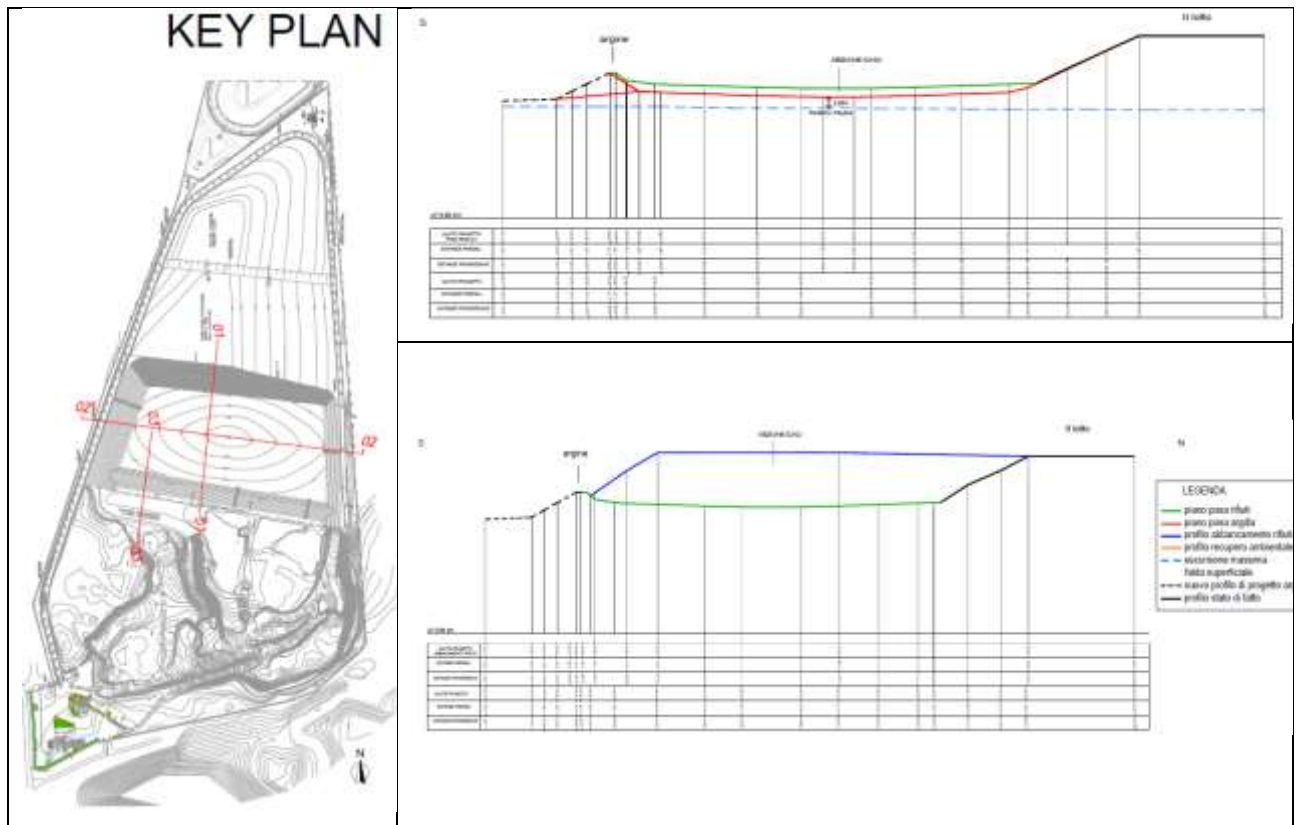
Sezione del lotto III in progetto con rappresentazione della posizione della falda idrica sotterranea al di sotto della discarica e della disposizione dei rifiuti prevista in progetto
